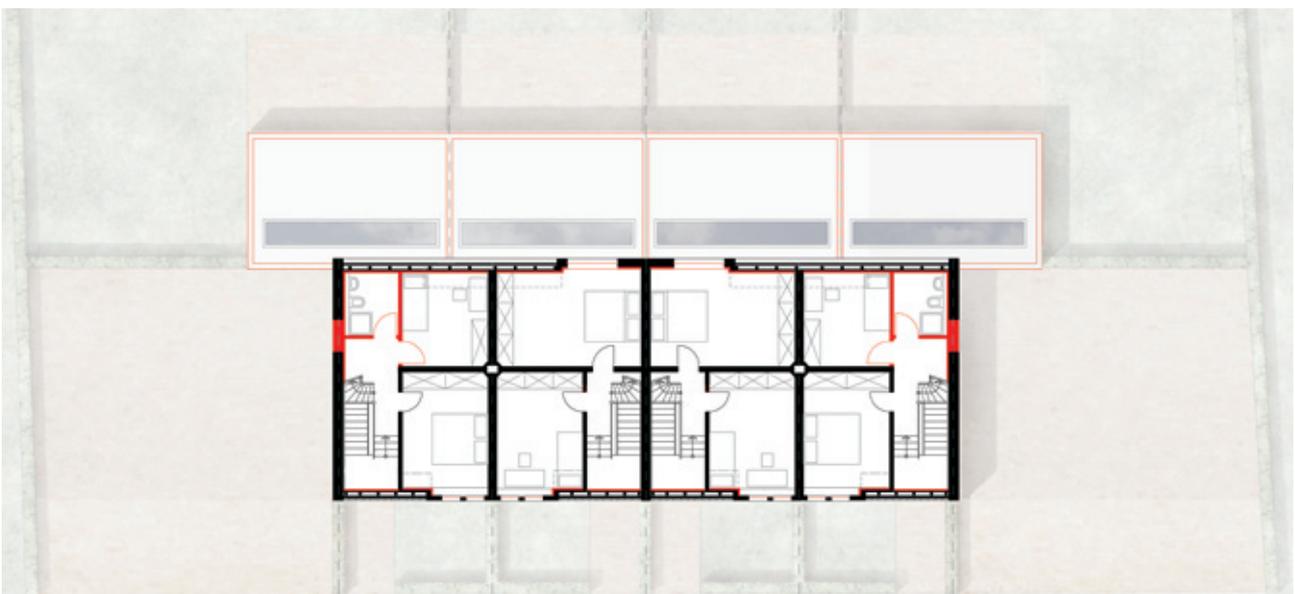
Grundriss 1. Obergeschoss Hausgruppe Variante II
